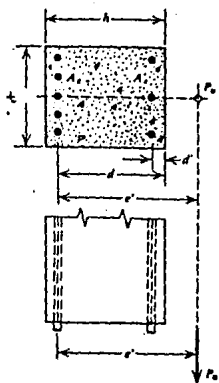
Sección rectangular de concreto con varillas en los extremos.
